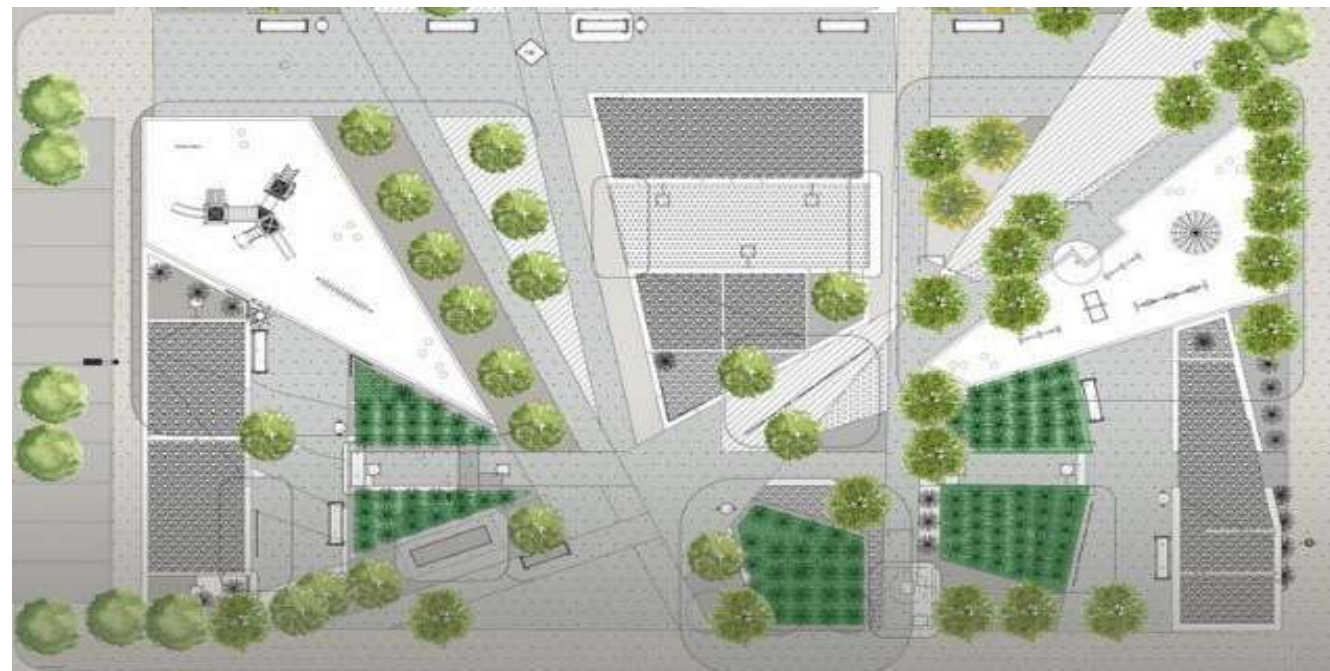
Planta de Conjunto. Autor: A. en Proceso
